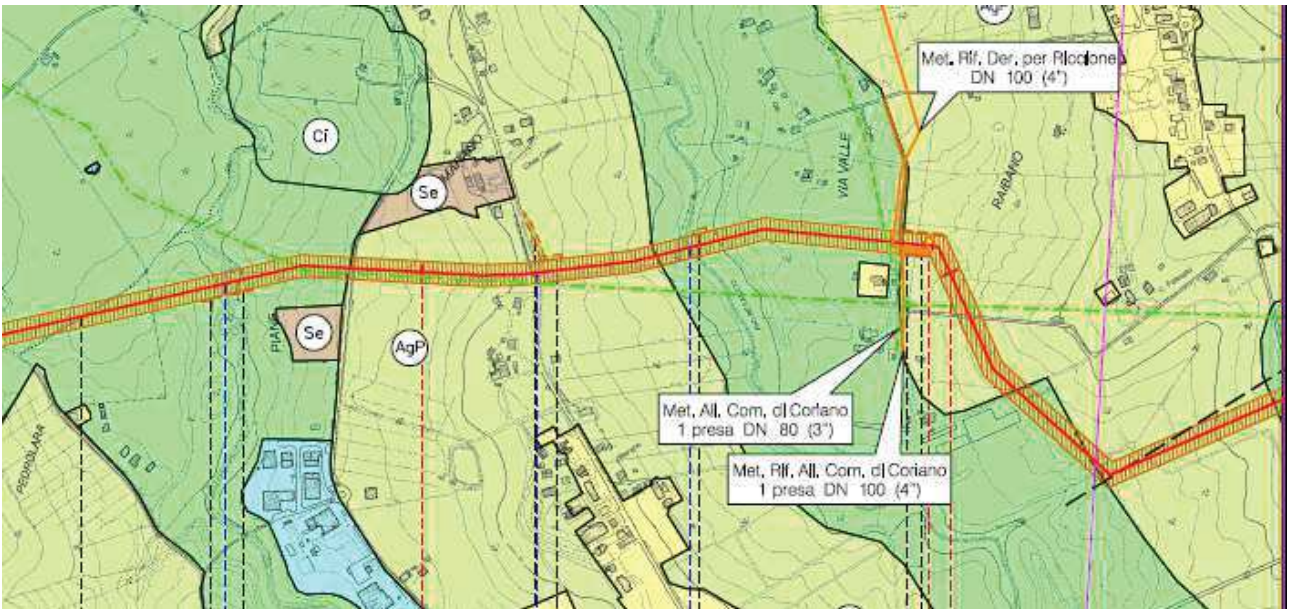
Stralcio Tav. PG-VPE-110 (Planimetria con VPE e strumenti di pianificazione urbanistica) – II° tratto (zona via Piane – Via Valle)
